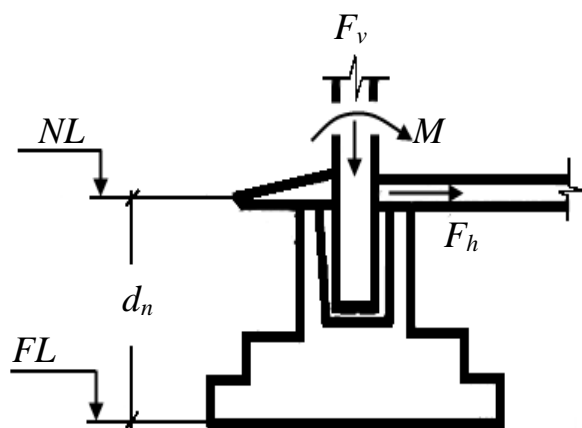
Схема фундаменту для будівель при відсутності підвальних приміщень. NL – позначка поверхні природного рельєфу; FL – позначка підшви фундаменту; d_n – глибина закладення підшви фундаменту
